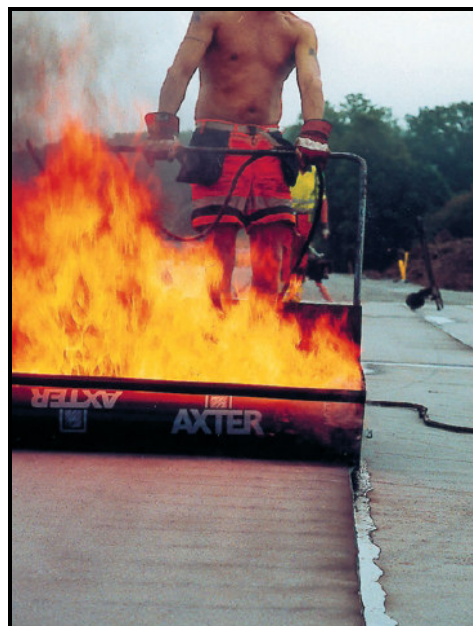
Tätskiktsmatta svetsas på den primade betongytan. (Jan Sandberg, Brobyggnad)
